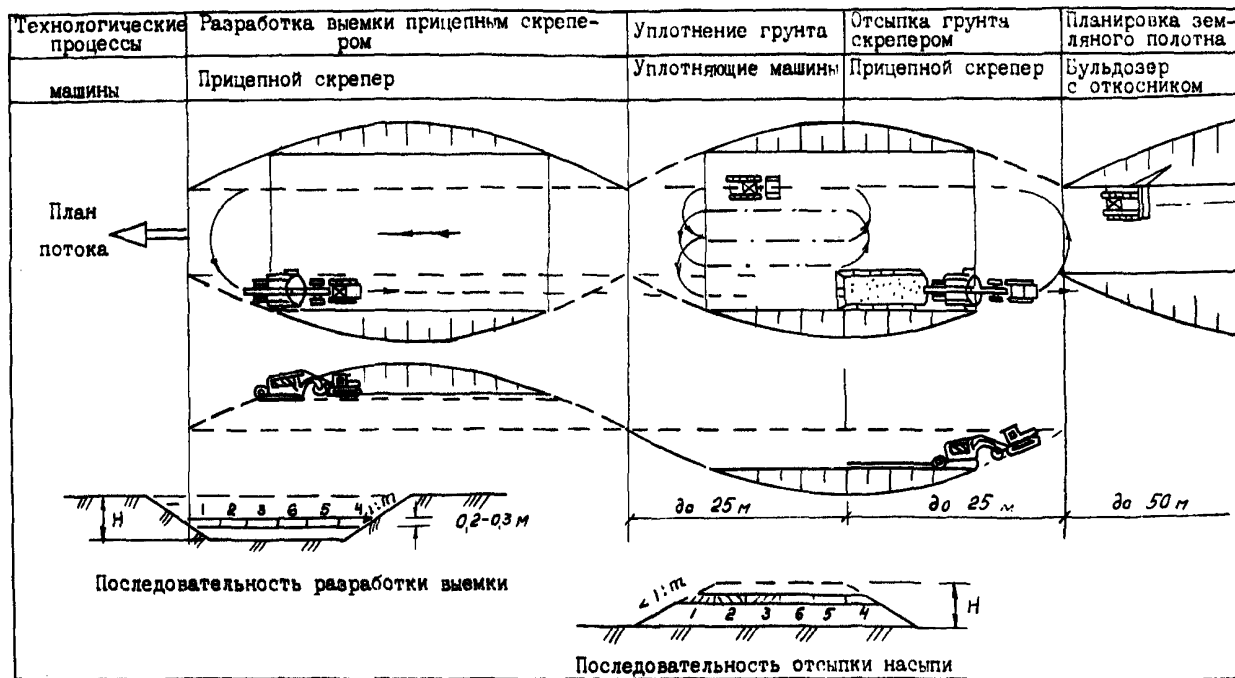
Схема разработки выемки с перемещением и укладкой песка в насыпь скрепером
